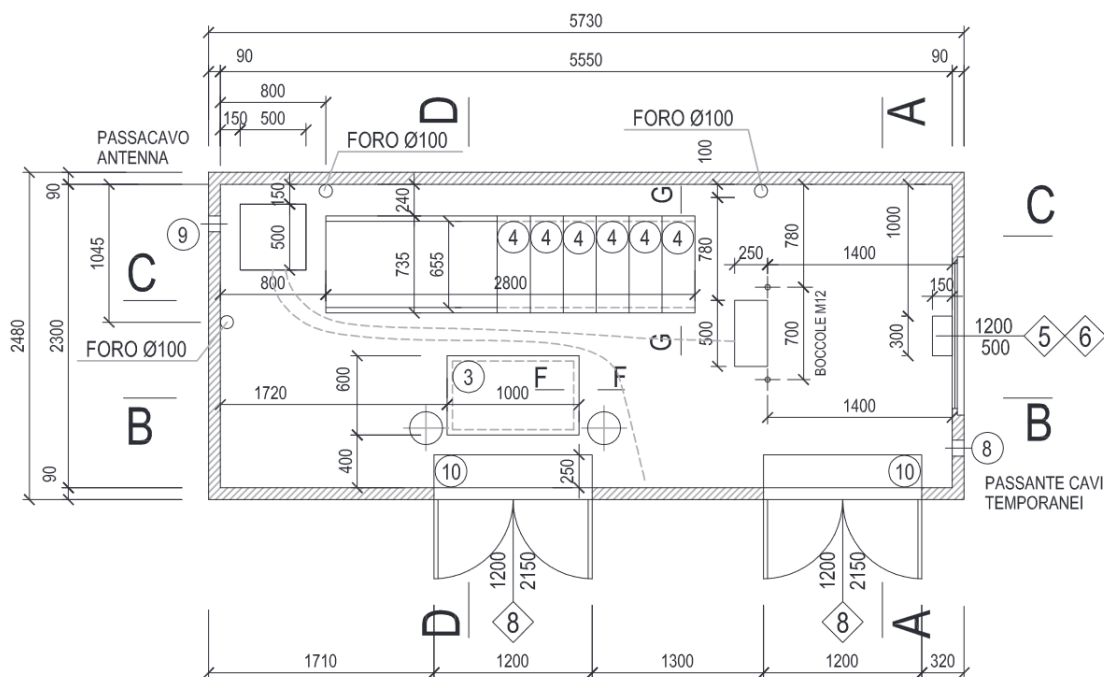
Pianta cabina di consegna DG 2061ed. 8
